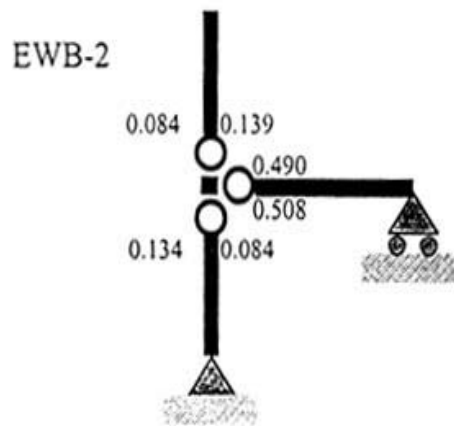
Mapa de daño final de una junta exterior viga plana-columna.
